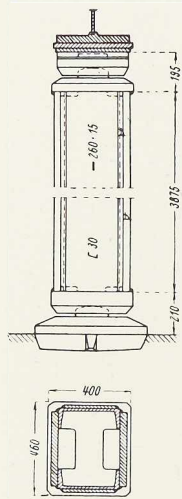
Appui pendulaire entièrement soudé.
